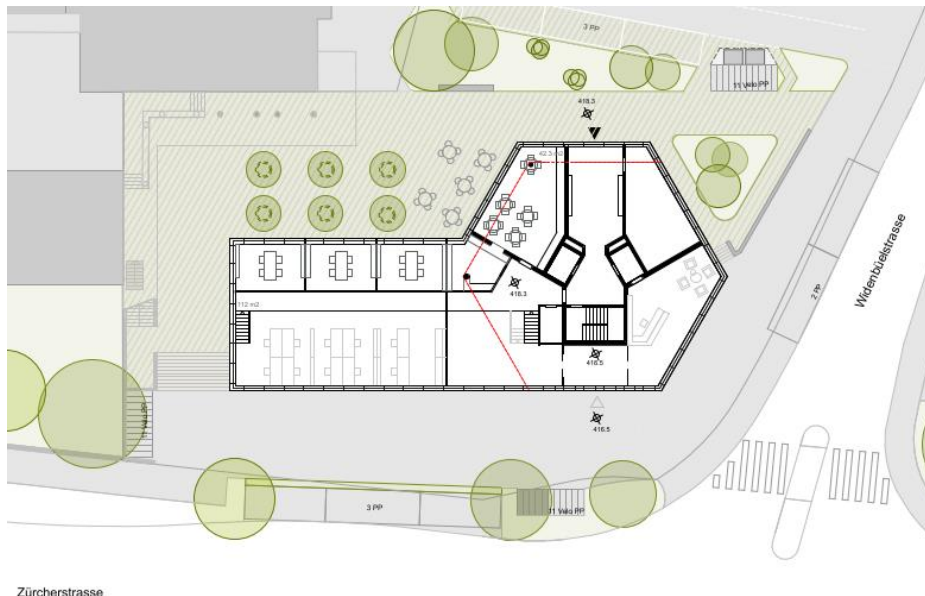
Richtprojekt, Ausschnitt Umgebungsplan. Corsten Städtebau, 26.3.2021
